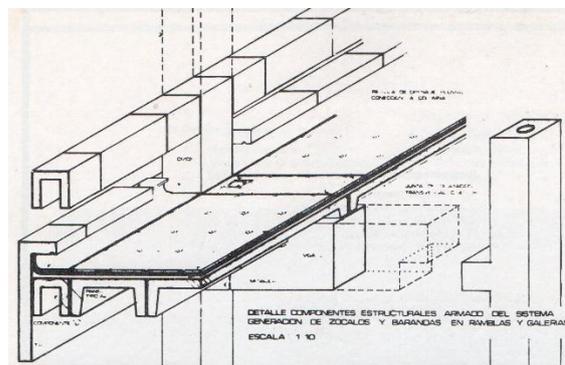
Detalle de componentes estructurales. Proyecto Punta Mogotes (1980).
